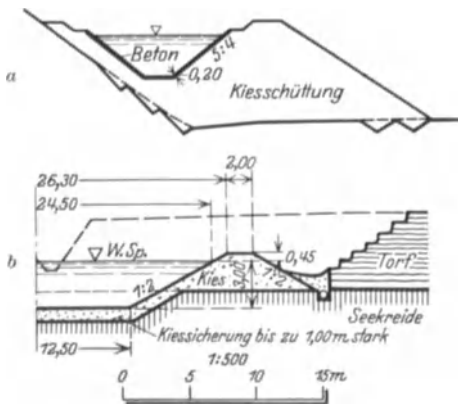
Walchenseewerk. a Hangstrecke bei Krün. b Loissachregulierung.
